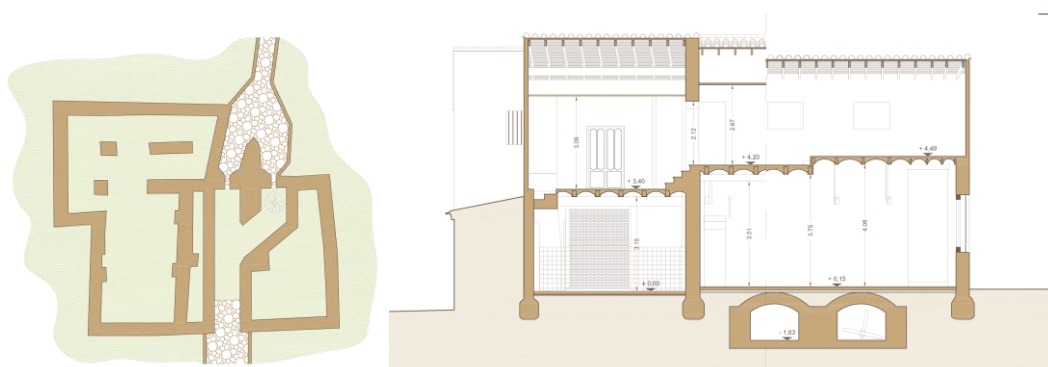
Plano en planta y sección del molino de Llobera. Estado actual.
